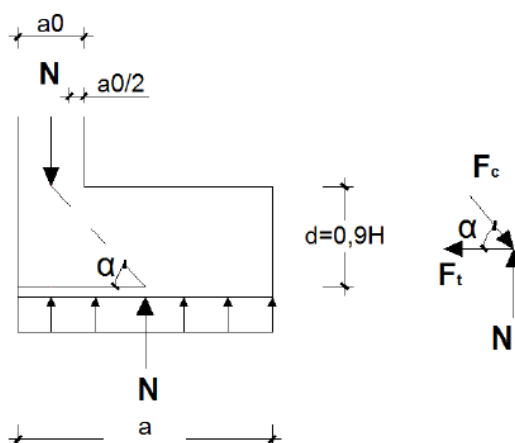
Esquema de cálculo das armaduras para sapatas laterais
